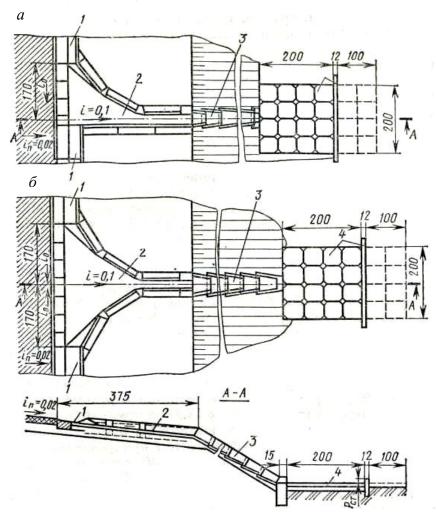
Сооружения системы открытого водоотвода с покрытия автомобильных дорог
